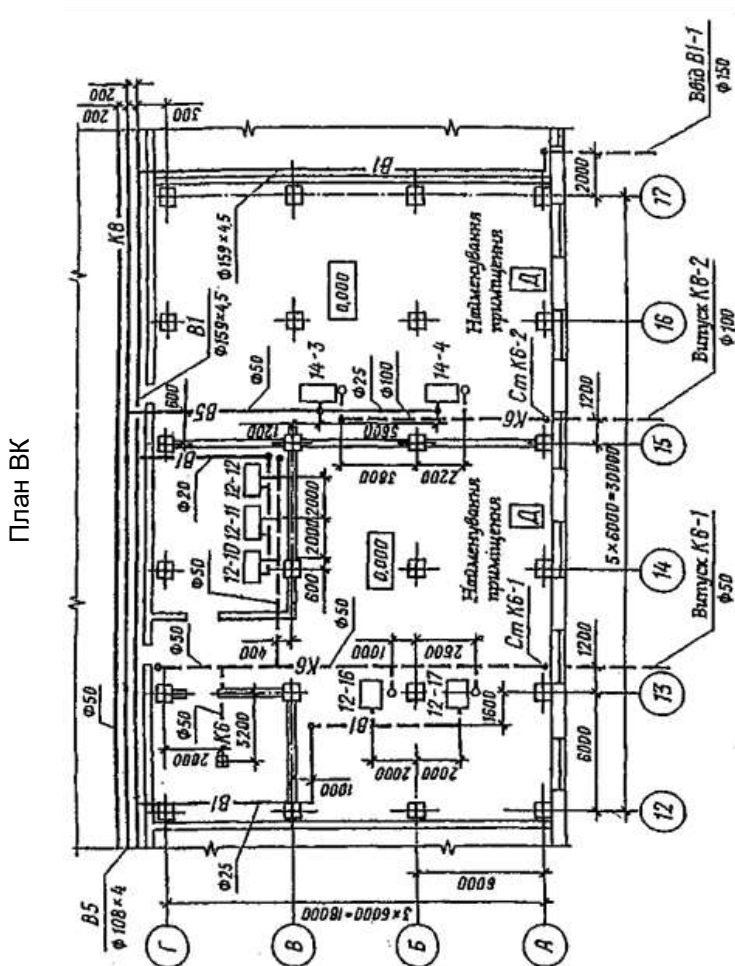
Приклад оформлення плану систем водопроводу і каналізації будівлі
